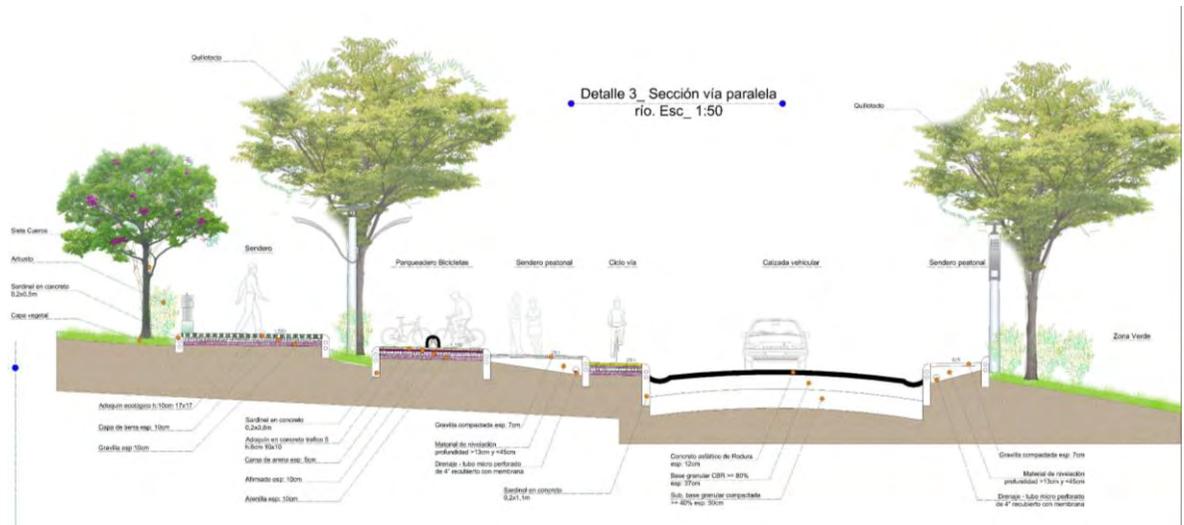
Sección Detalle Vía Paralela. Fuente: Elaboración Propia
